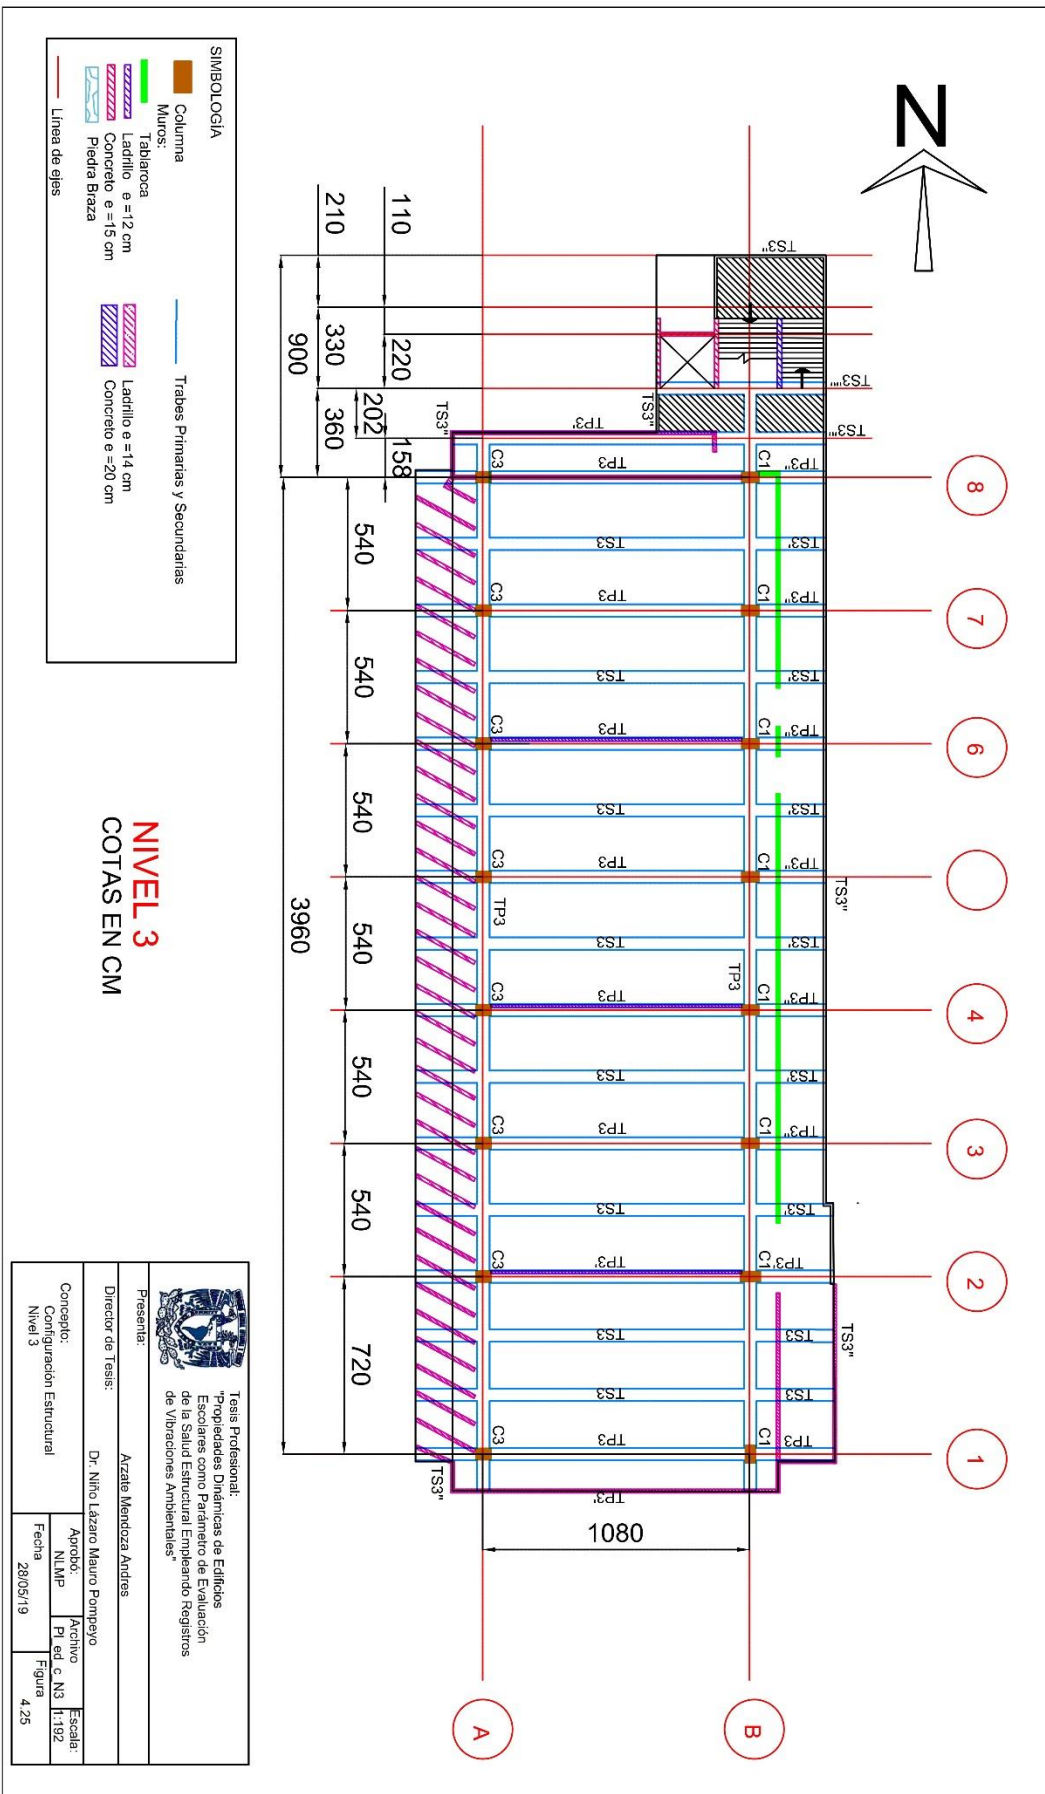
Planta estructural nivel 3 edificio C FI, UNAM
